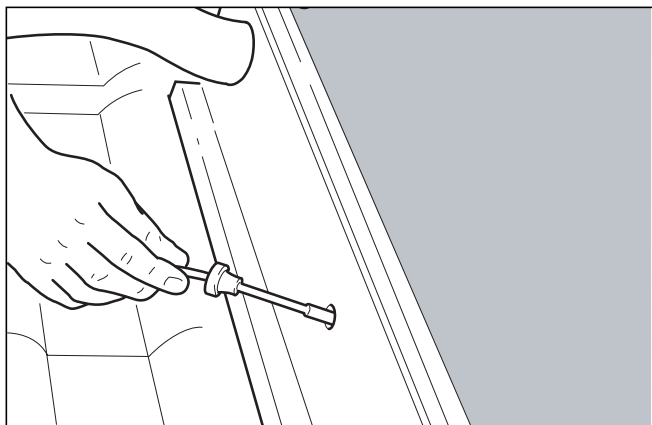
De collector aan de onderkant en bovenkant met bevestigingsklem zo aan montagerail vastzetten dat ingestanste pijl naar de collector wijst.
